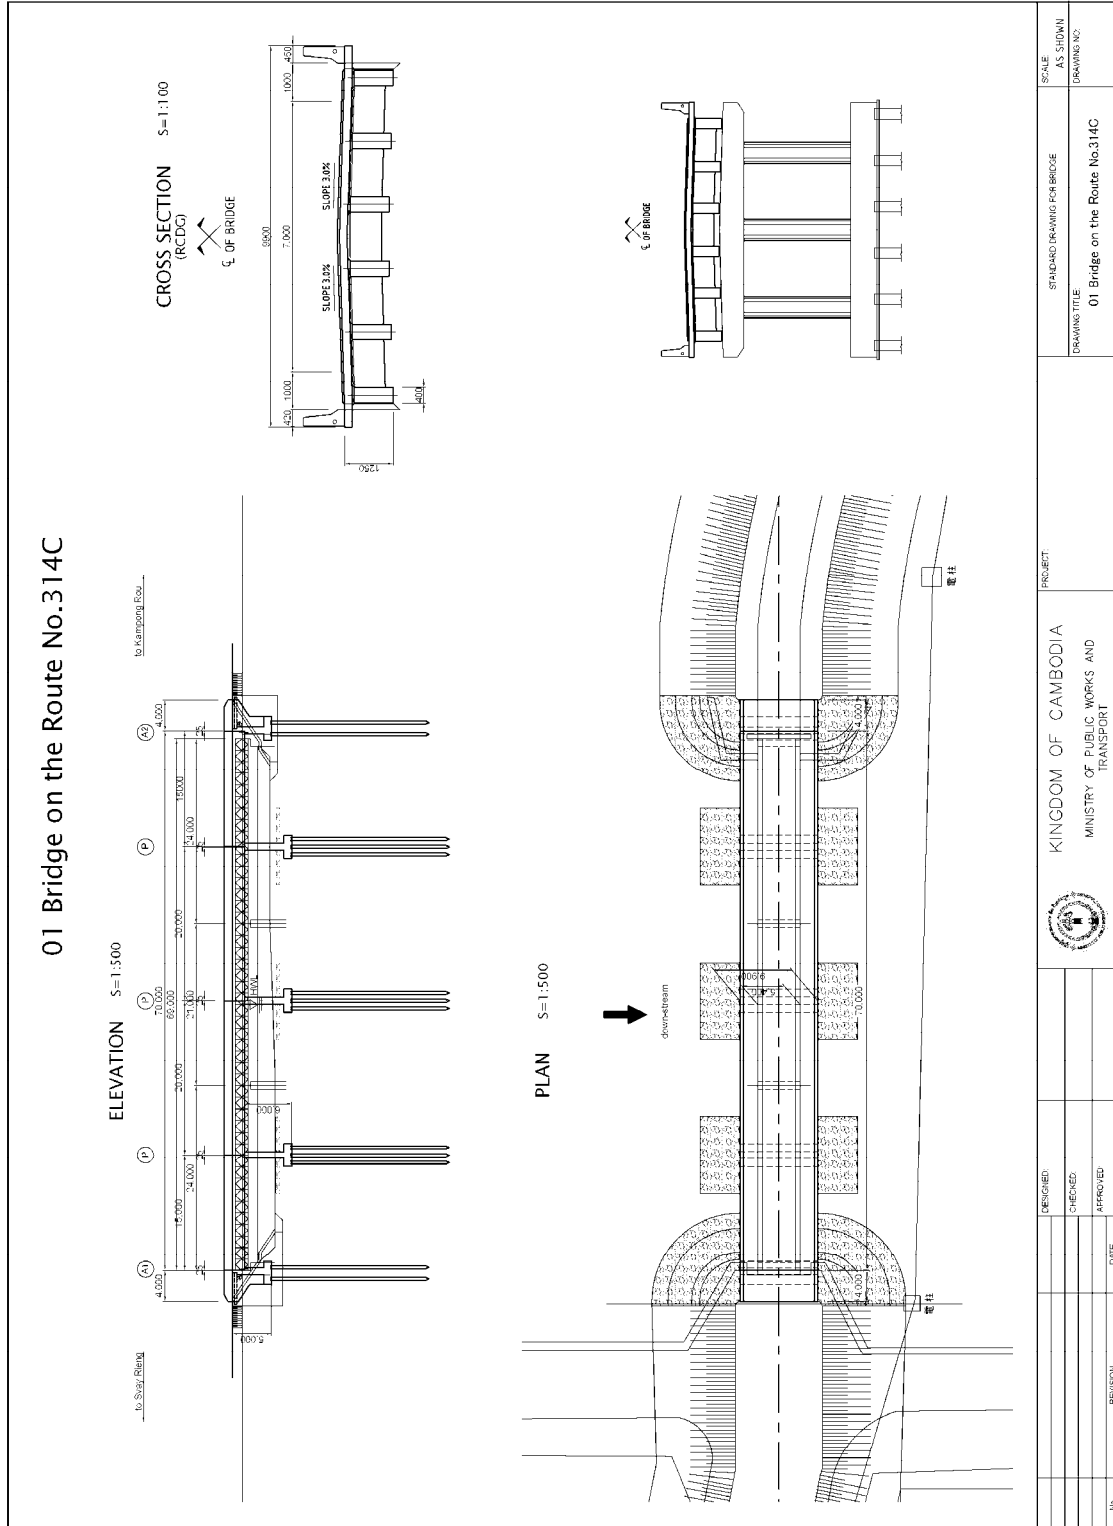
橋梁一般図 (No1 Bridge on the Route 314C)
